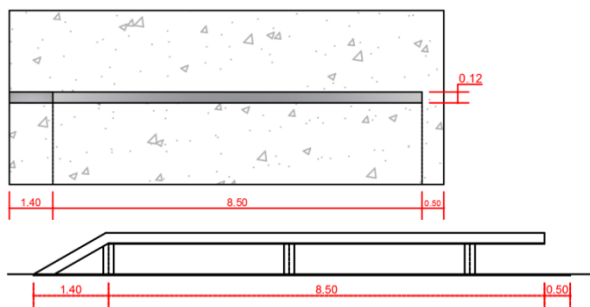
Vista en planta y lateral del obstáculo.
